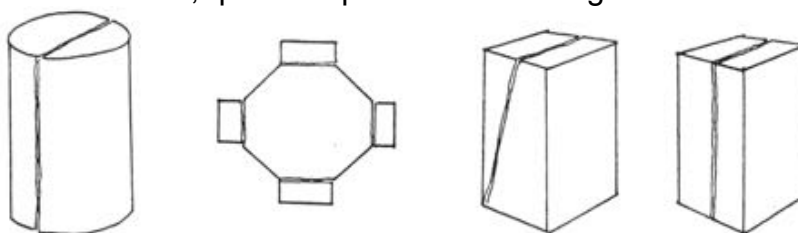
ROTURA DE PILASTRAS Y COLUMNAS
